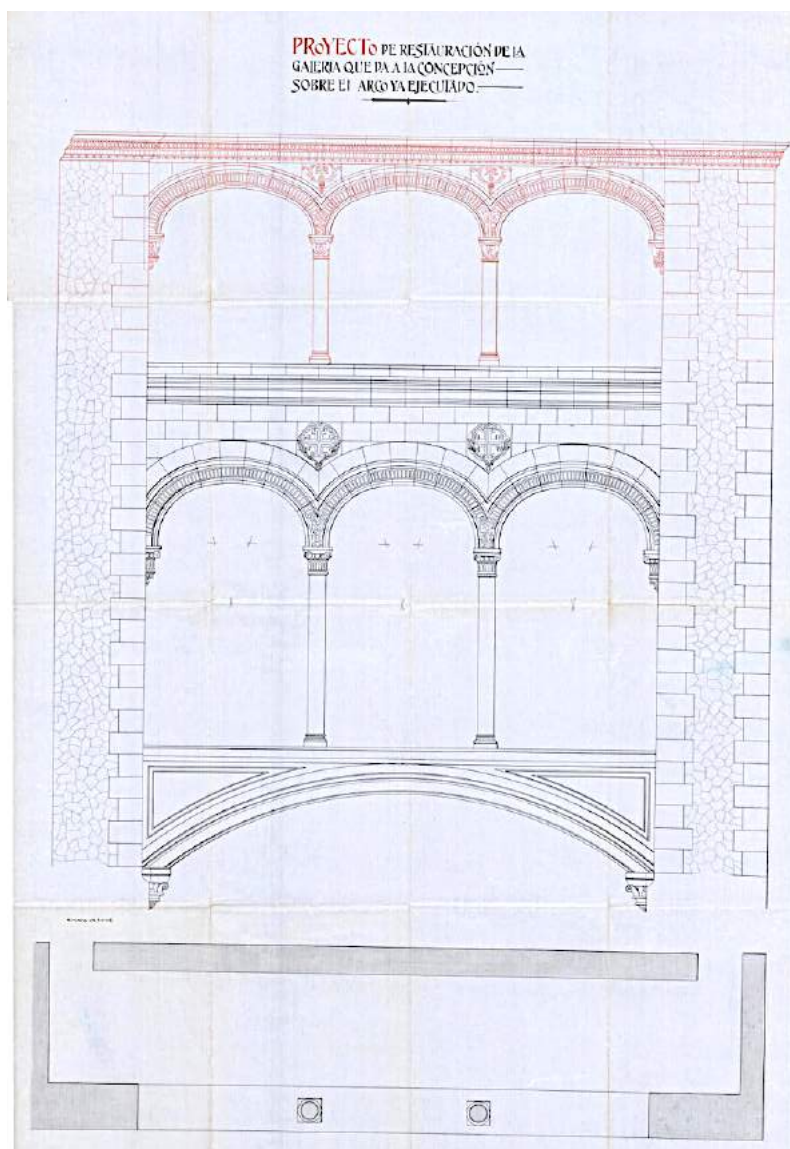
Alzado del Balcón. Proyecto de obras para la terminación de la arquería superior, 1928. Fuente: A.G.A. 31/04894 017
